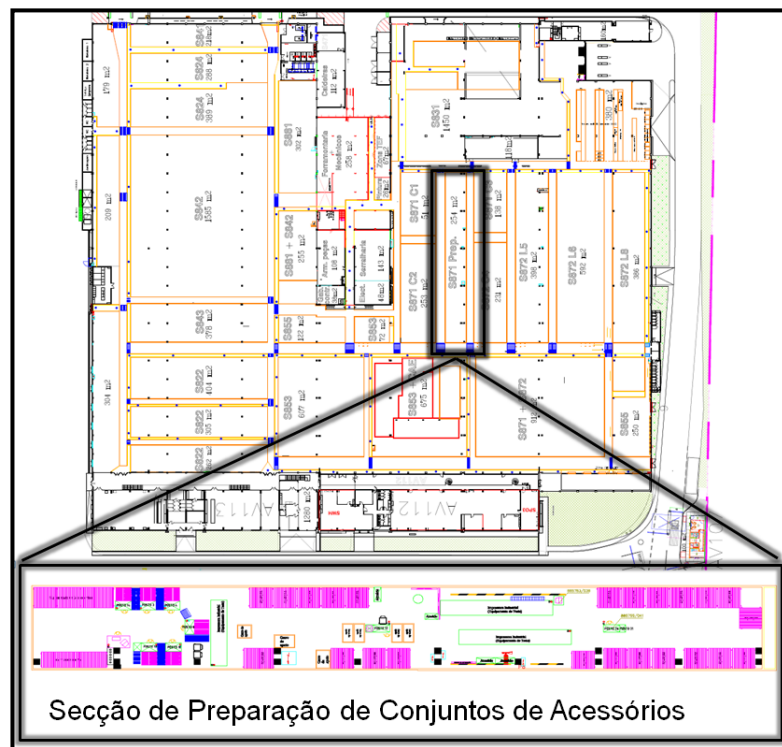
Localização e Layout da Secção de Preparação de CA.
